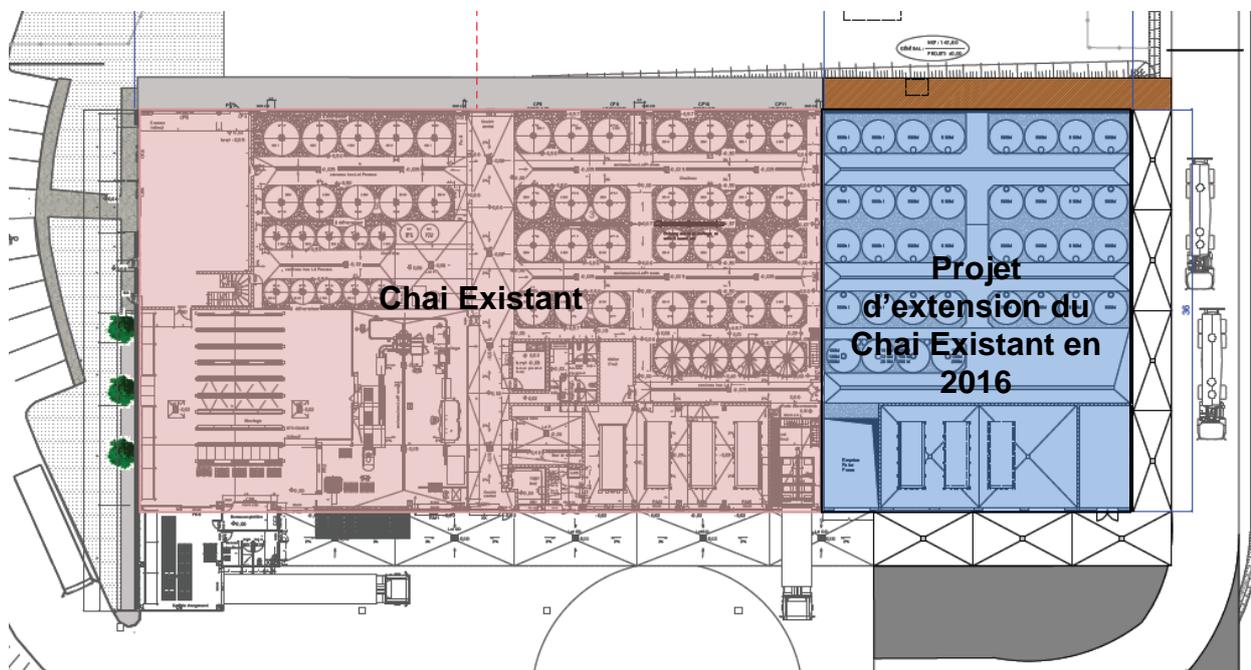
Plan de masse du Chai Existant – Projet d'extension
